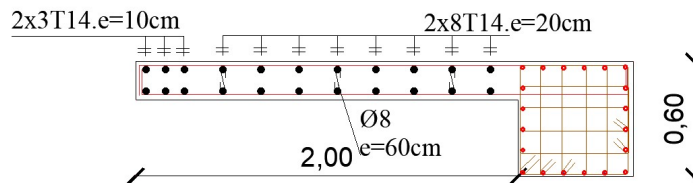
Exemple de ferrailage du voile RDC (L= 2.00 m)
